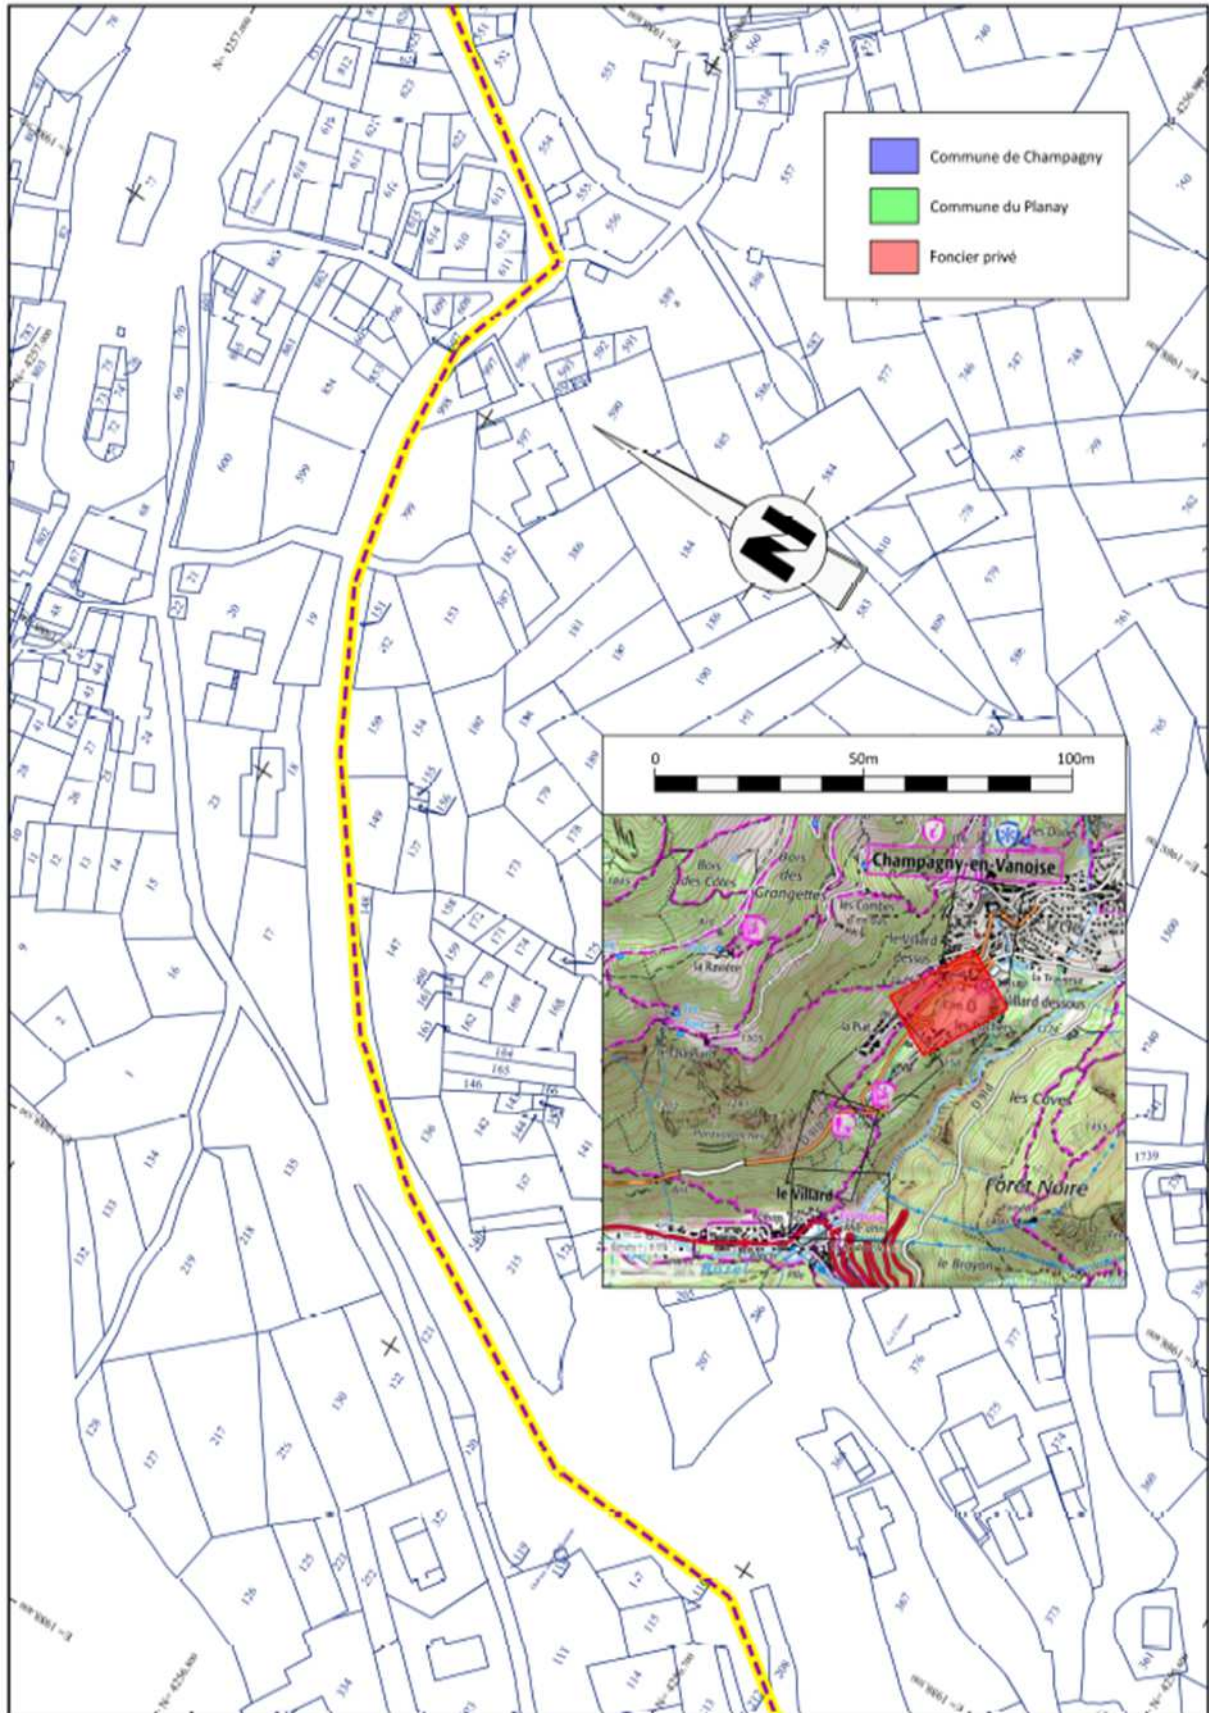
Implantation des ouvrages sur fond de plan cadastral - planche 2/5
